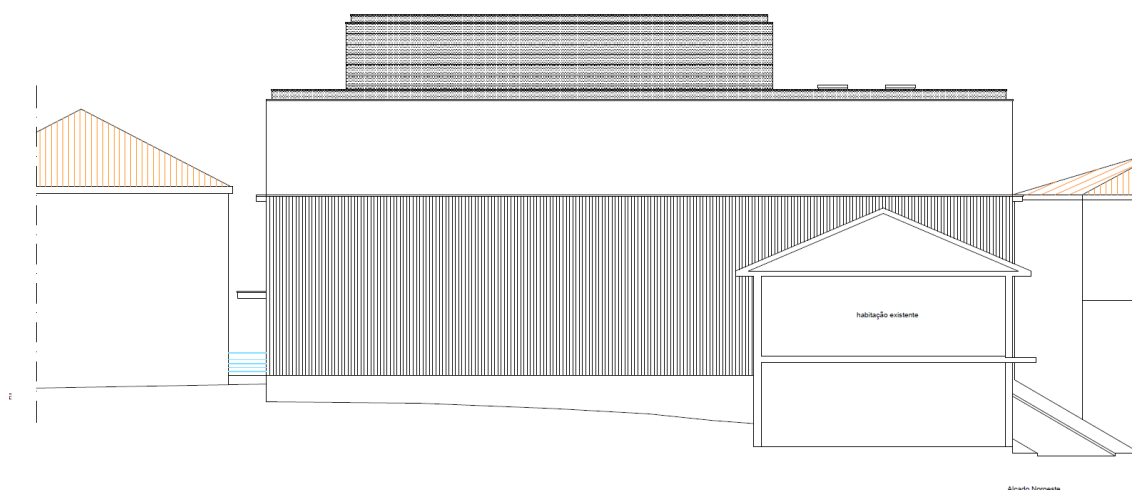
Alçado Noroeste. Fonte: Corcovado Construções.
